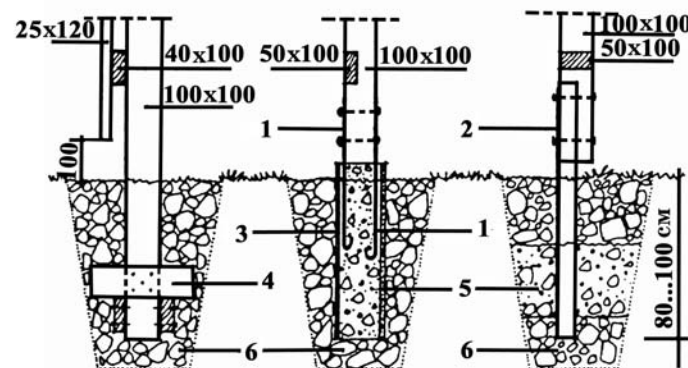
Столбчатые фундаменты: 1 – соединительная деталь; 2 – швеллер № 10; 3 – труба асбестоцементная; 4 – пропитанная древесина; 5 – бетон; 6 – щебень.
